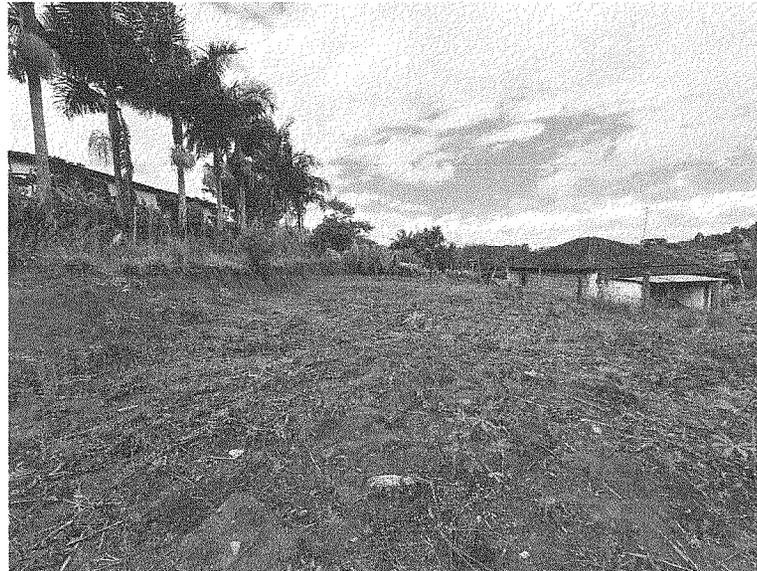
Vista Panorâmica interna (frente aos fundos).
